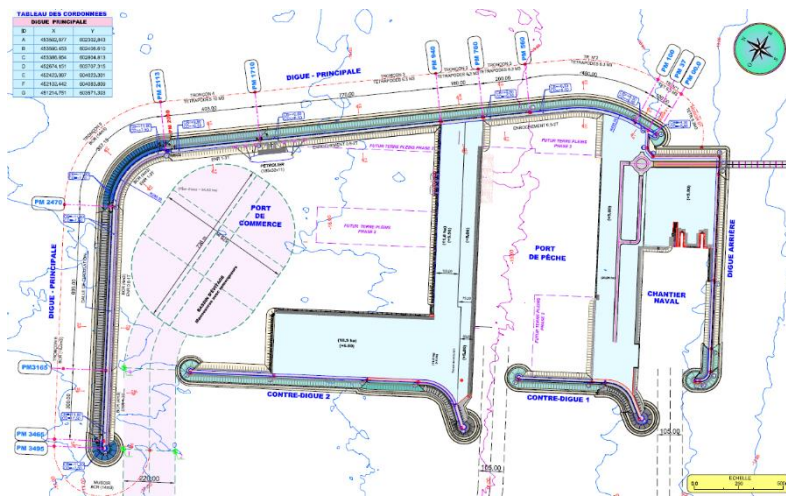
Planta com a configuração final das obras de Fase 1 do Porto de Dakhla Atlantique
